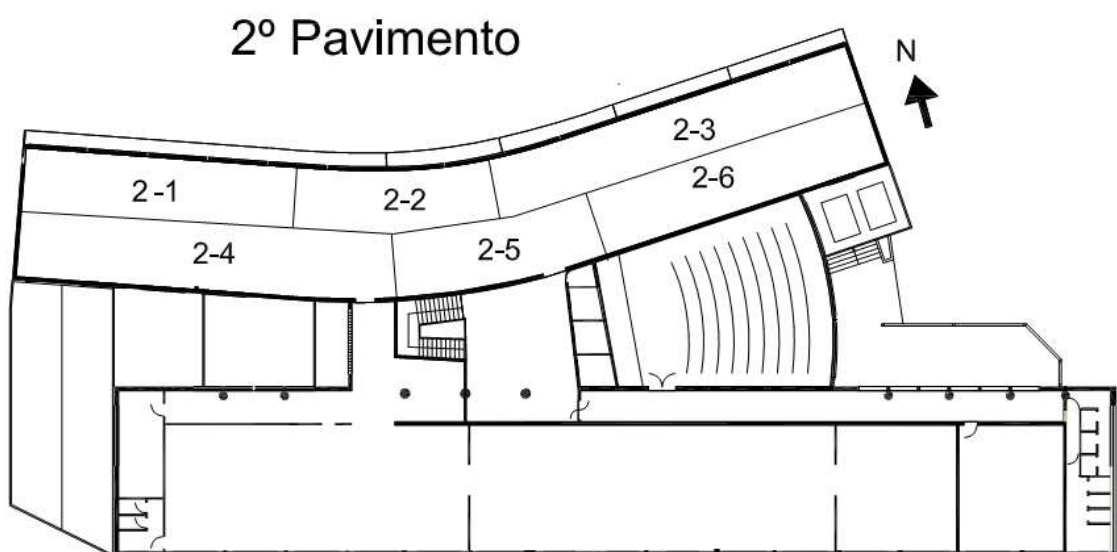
Planta baixa do segundo pavimento térreo com as 6 zonas térmicas.
